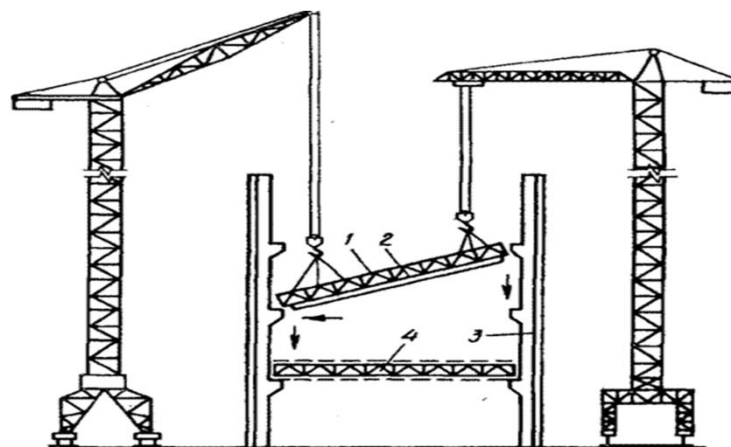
Монтаж тяжёлых конструкций двумя башенными кранами: 1 – монтажная ферма, 2 – усиление нижнего пояса фермы,
